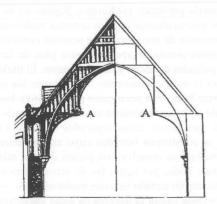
Armaduras y detalles del arranque de la propuesta de De l'Orme (Newlands 1860)
